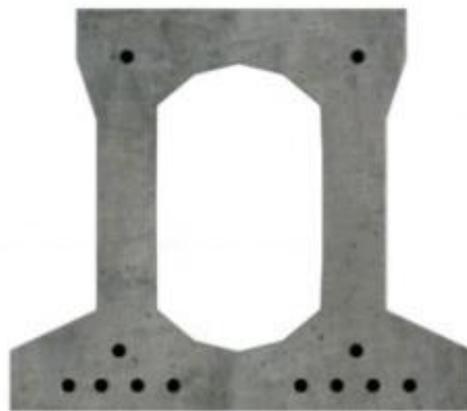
Sección en caja para concreto preesforzado y postensado. McCormac & Brown, 2011. *Diseño de concreto reforzado.* Pág. 568.
